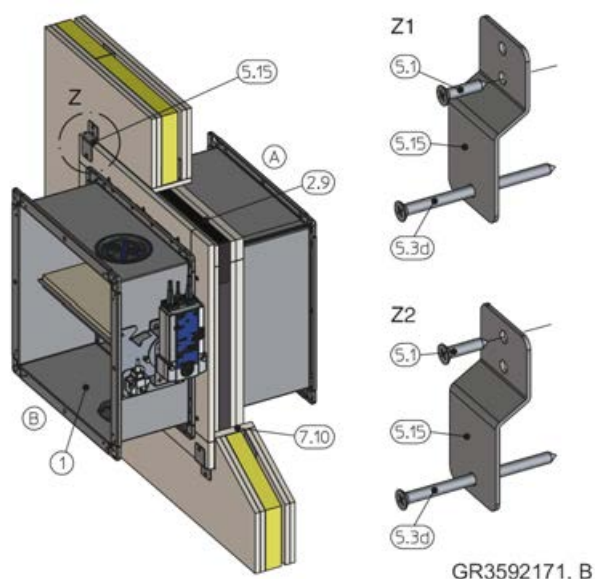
Fissaggio del kit d'installazione ai montanti in metallo
